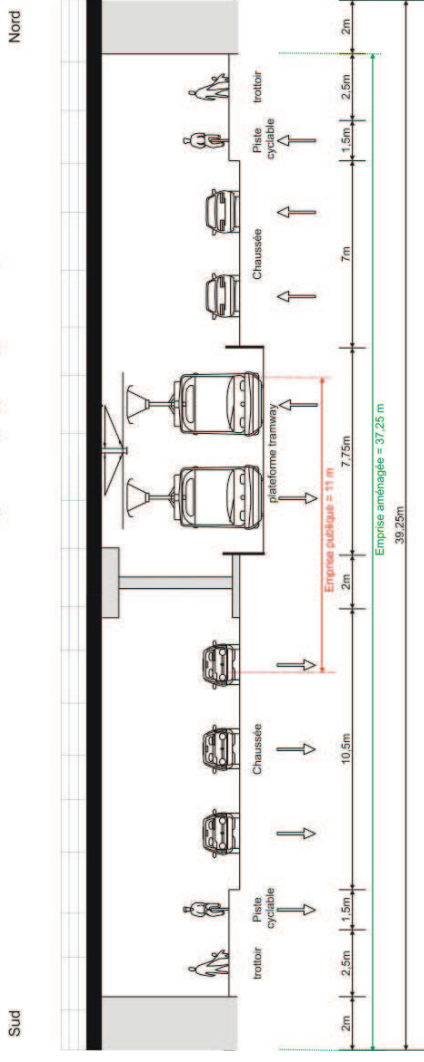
Situation projetée coupe 32 sur la rue de Koenigshoffen (variante élargissement des ponts)
